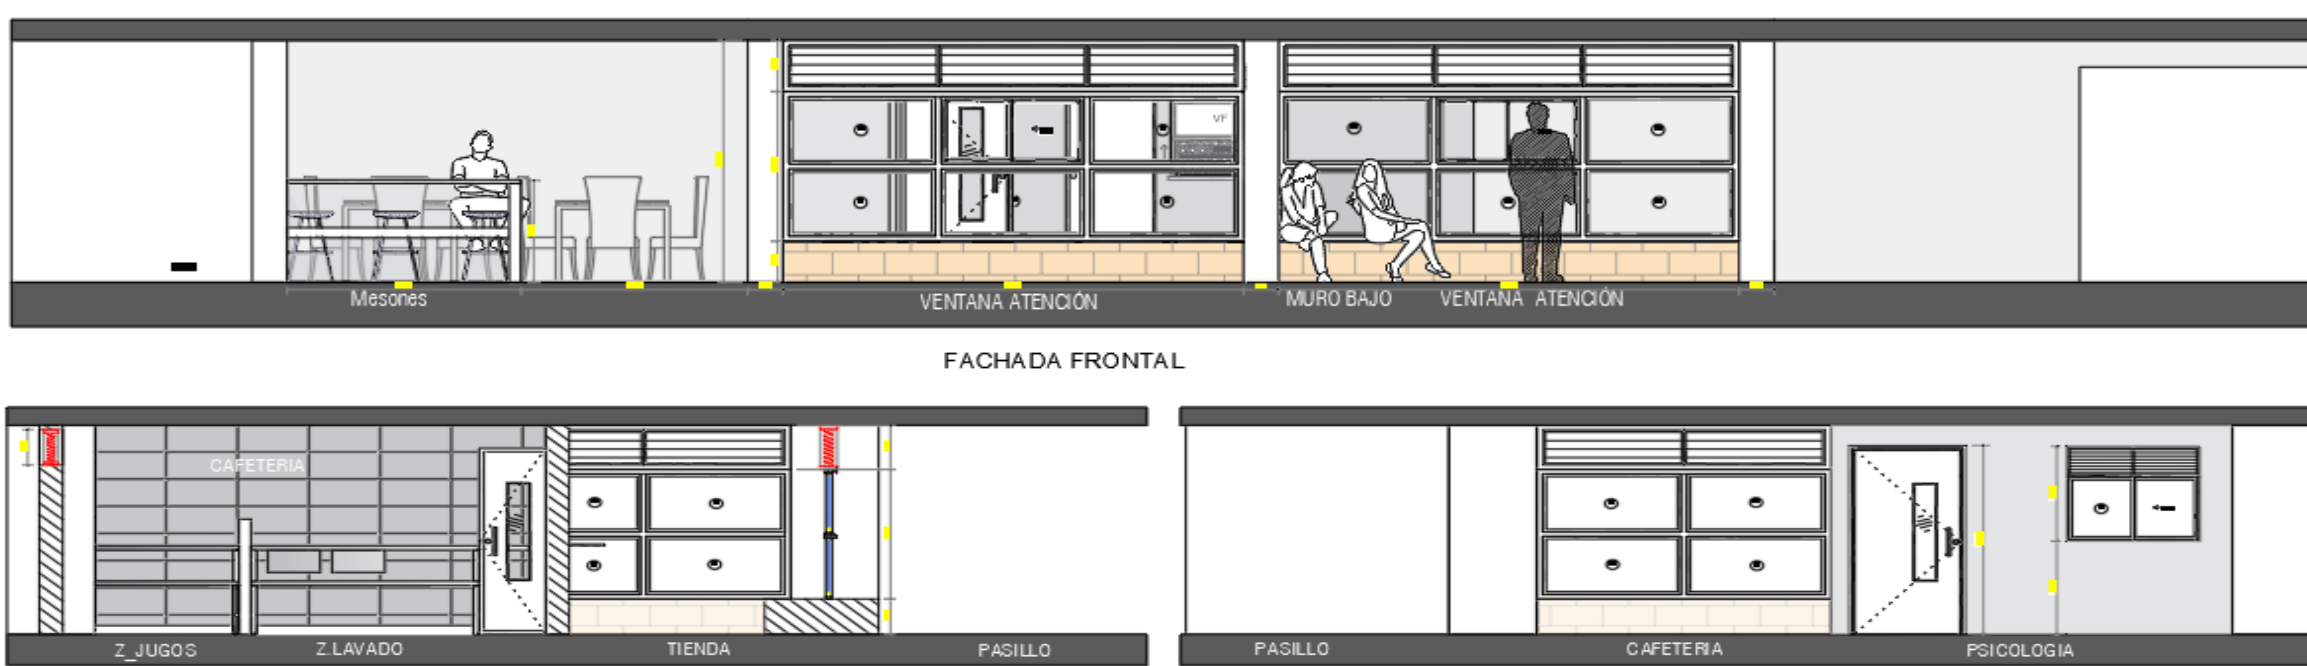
Adecuación Cafetería I.E. Gilberto Avendaño.
